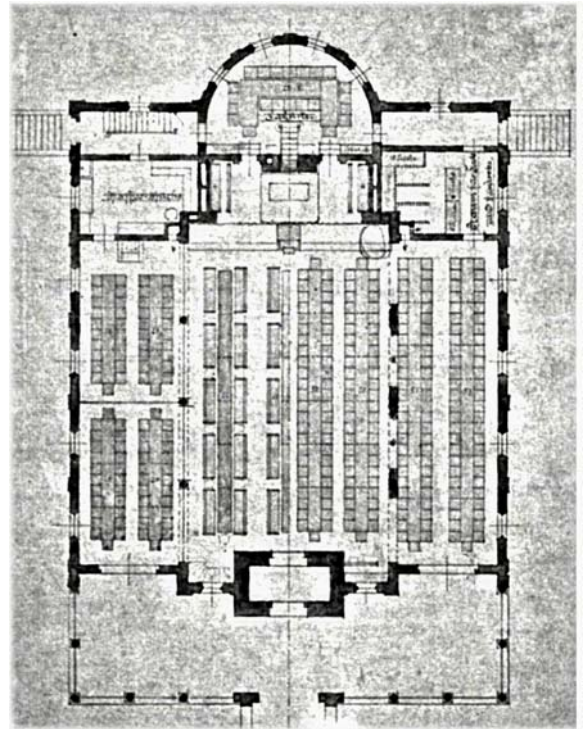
Grundrissplan mit Möblierung bei Veranstaltungen, Entwurf Moritz Korn (1905), Kanzelaltar bei der Bauausführung nicht realisiert
